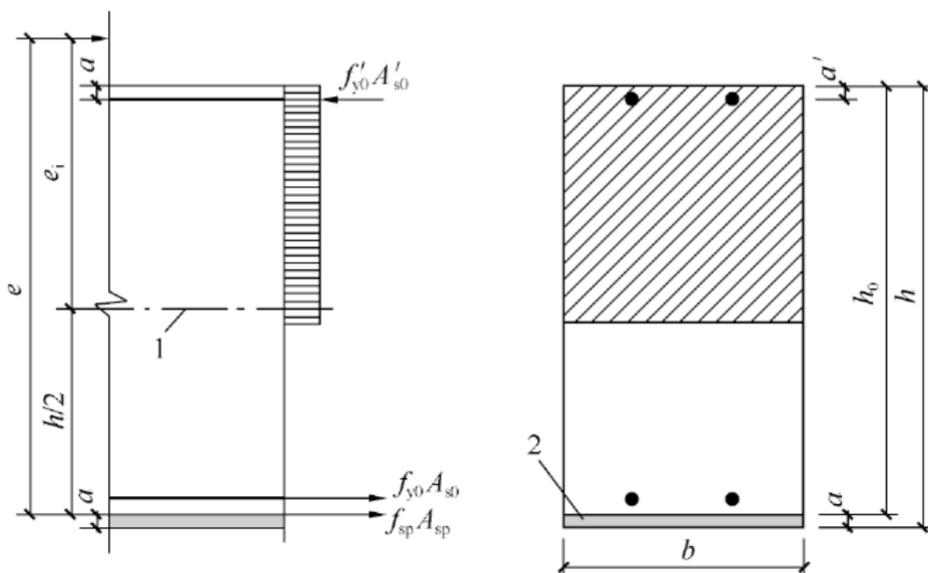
矩形截面大偏心受压构件粘钢加固承载力计算
